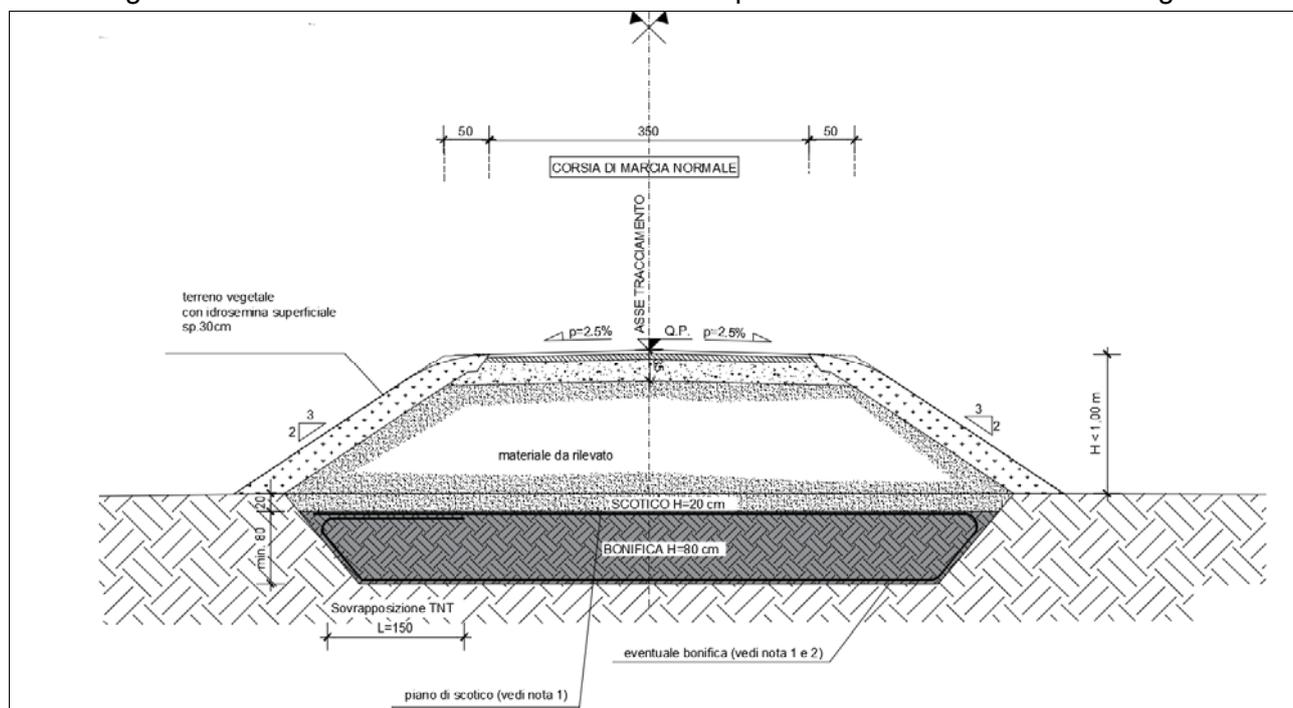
SEZIONE TIPOLOGICA IN RILEVATO DELLA RICUCITURA VIABILITÀ RURALE LUNGO ADDA 4 NOVEMBRE
